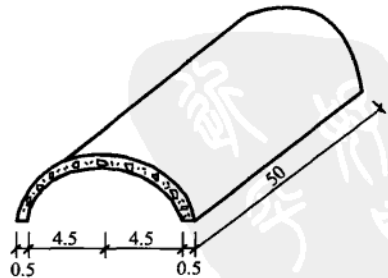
桩顶混凝土圈梁示意图 (单位:m)
